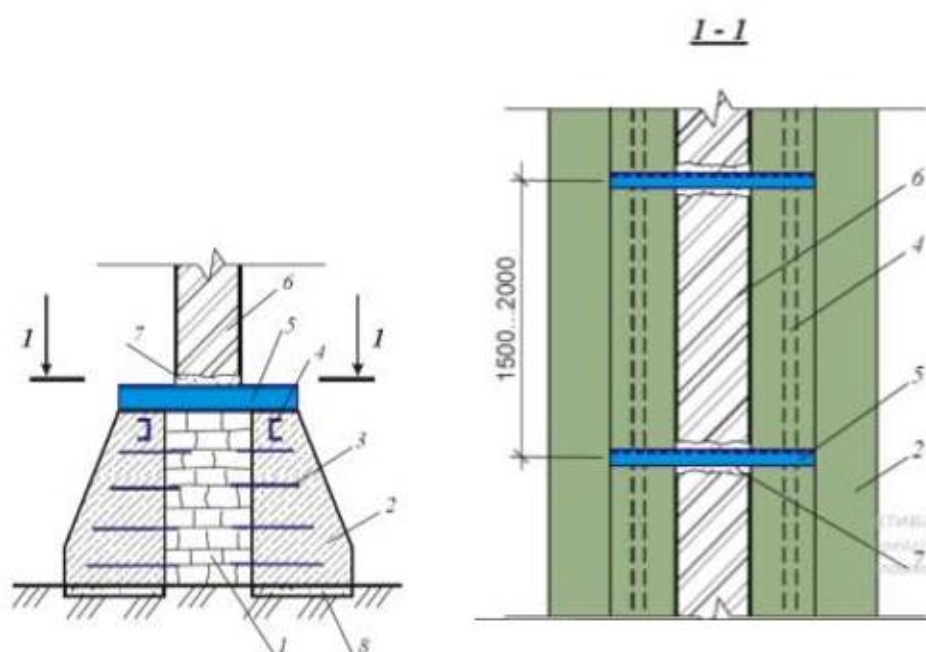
Підсилення фундаментів монолітними бетонними поширеннями підшви.
